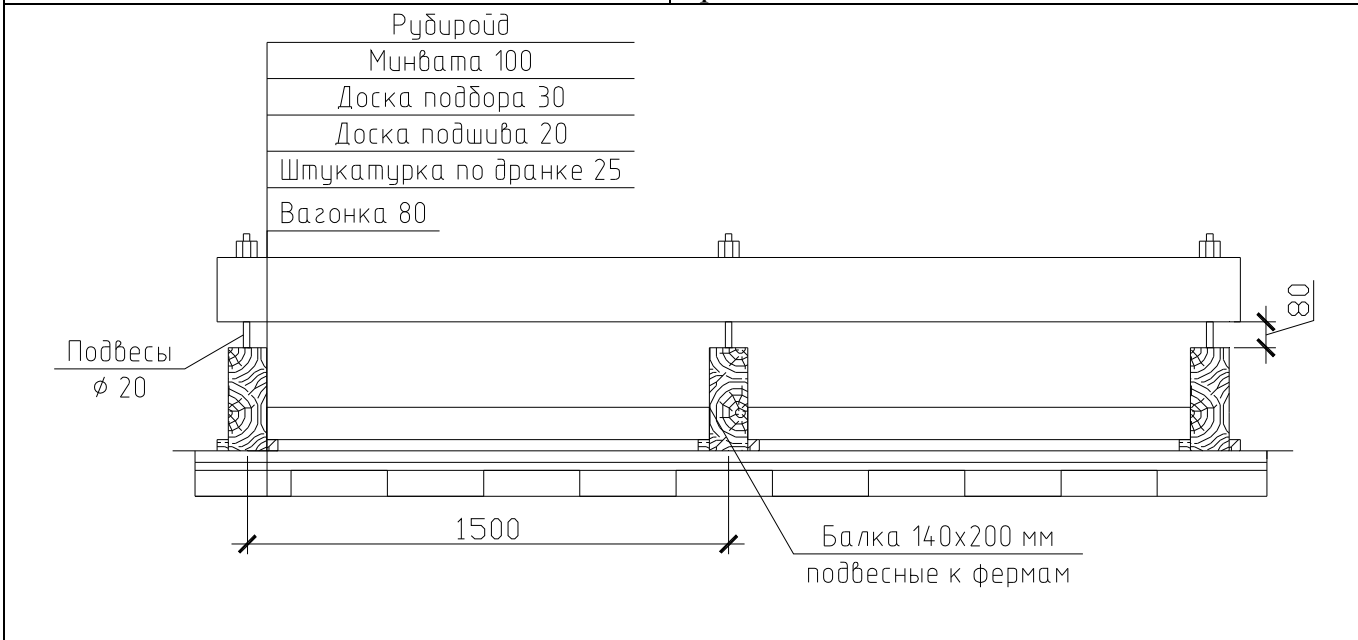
Подвесное перекрытие над пятым этажом (над спортивным залом) в осях «9–11/А–В»
